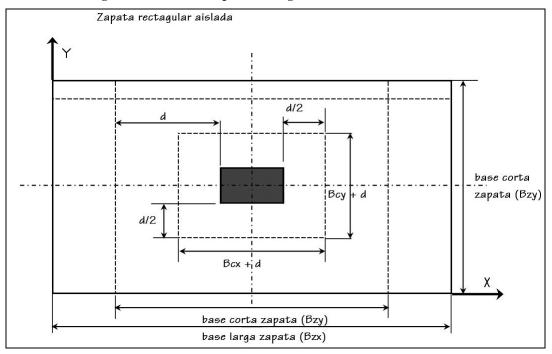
Detalles de zapata rectangular aislada sin excentricidad
